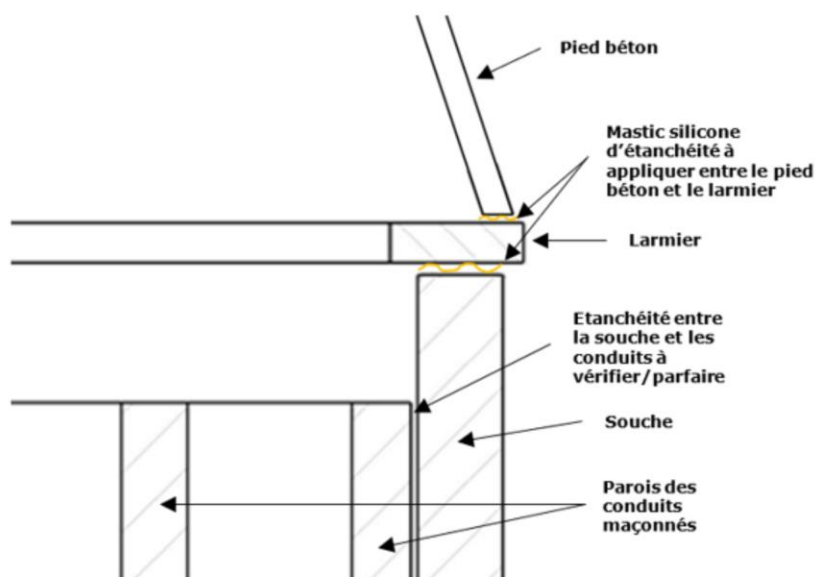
Coupe verticale d'un pied béton sur un larmier avec suppression de la dalle existante
